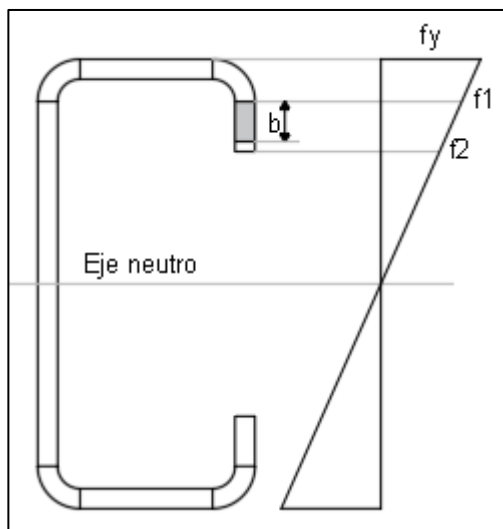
Anchos efectivos de la sección transversal del perfil conformado en frío tipo doble G.
